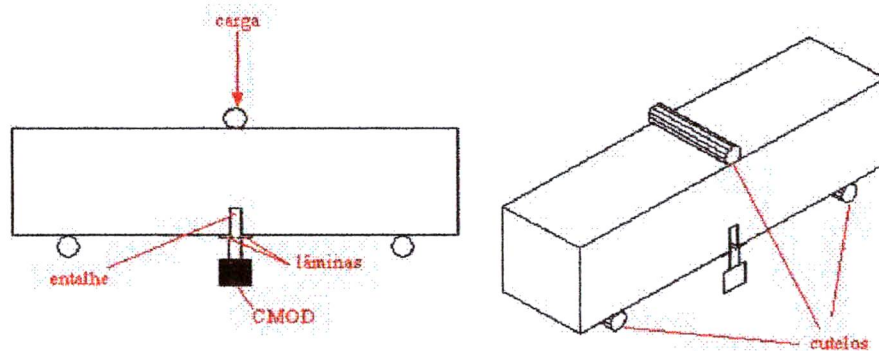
Ensaio de flexão com três pontos de carregamento, utilizando o sistema CMOD para leitura de abertura de fissura.
